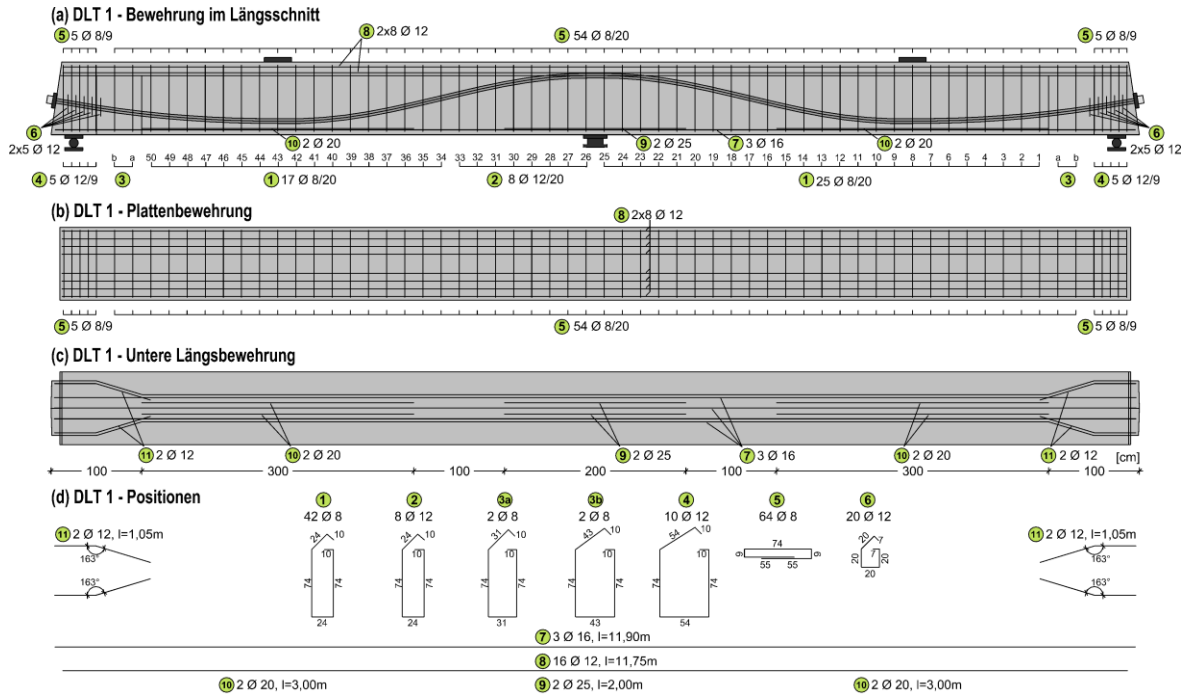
Bewehrungsplan Versuchsträger DLT 1
